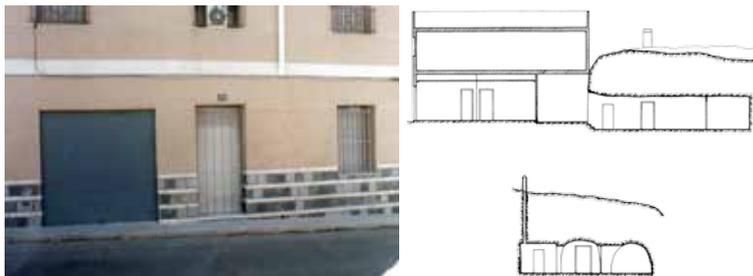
y 14: Fotografía y secciones de vivienda-cueva con construcción delantera. Situada en C/ Vereda Hospital. Fuente: (García Aznar y López Davó 2000).
